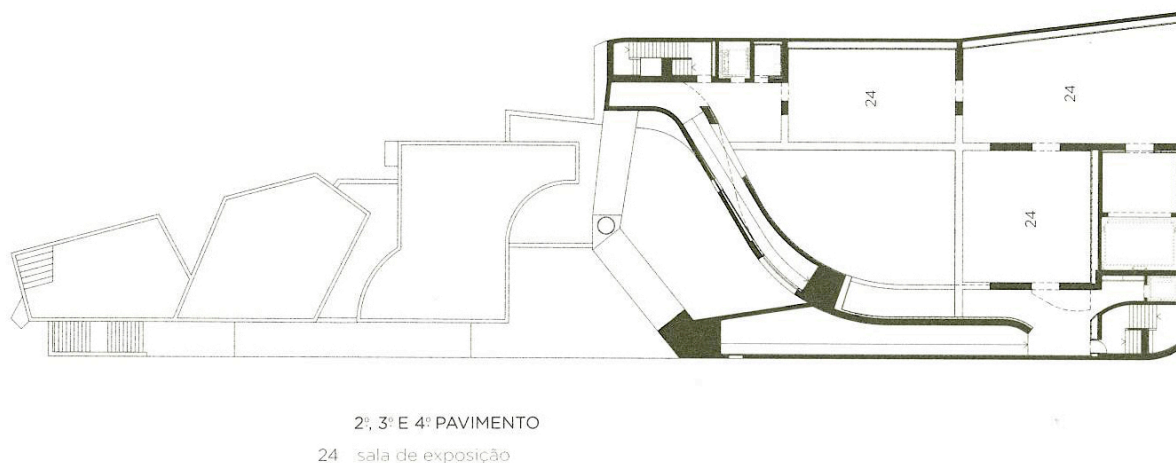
Planta Baixa tipo dos pavimentos expositivos. Fonte: Figueira (2008, p. 44).
